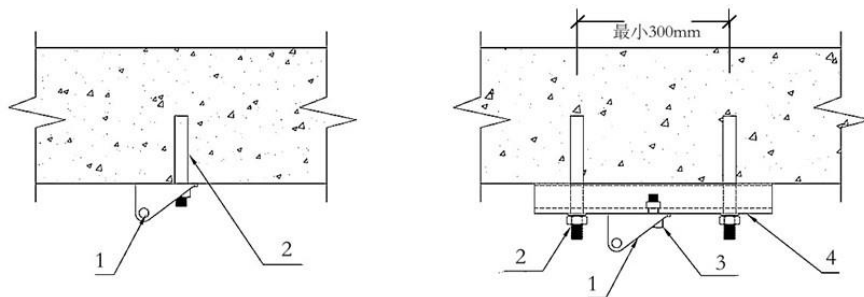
抗震连接构件根部构造示意图（钢筋混凝土结构）
